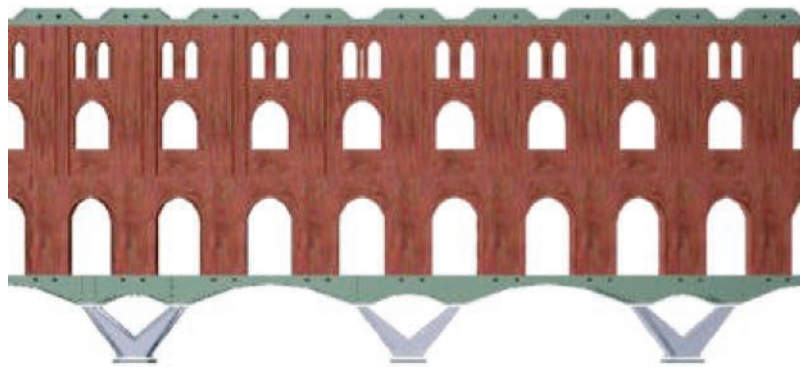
Alzado de fachada sobre viga-arco y pilares definitivos
